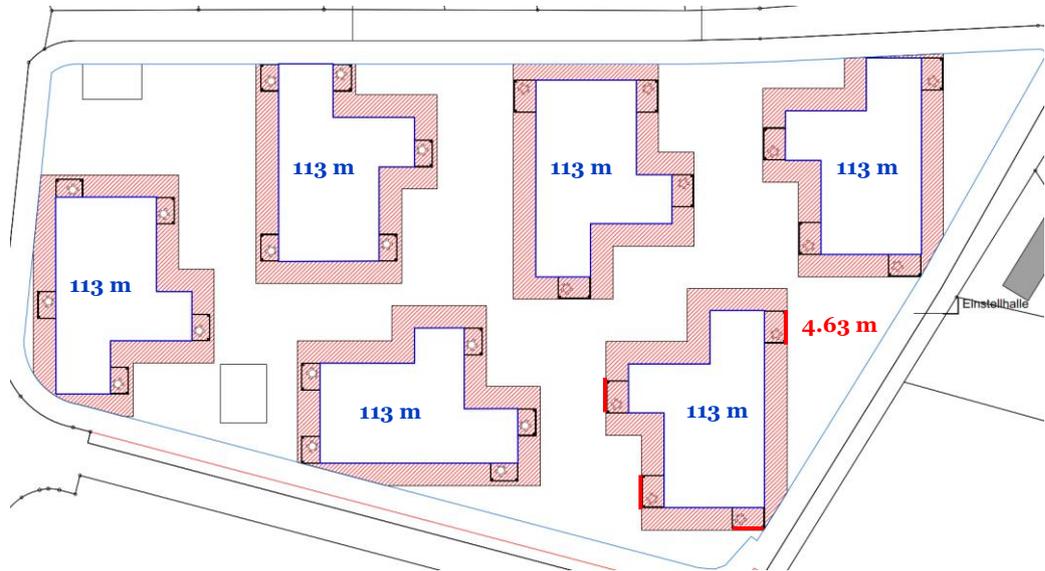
Nachweis Fassadenumfang (blau) im Vergleich zur Balkonbreite (rot)
